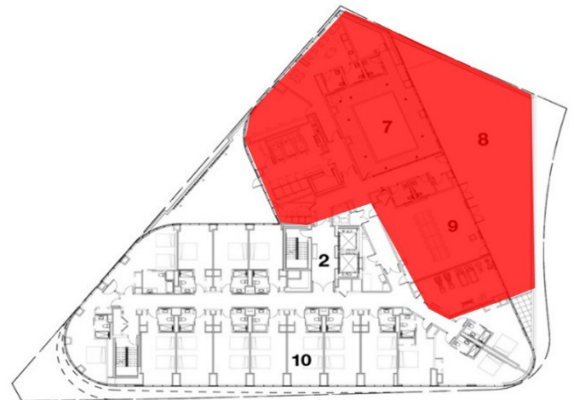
plan d'étage supérieur de l'hôtel Hilton Garden
